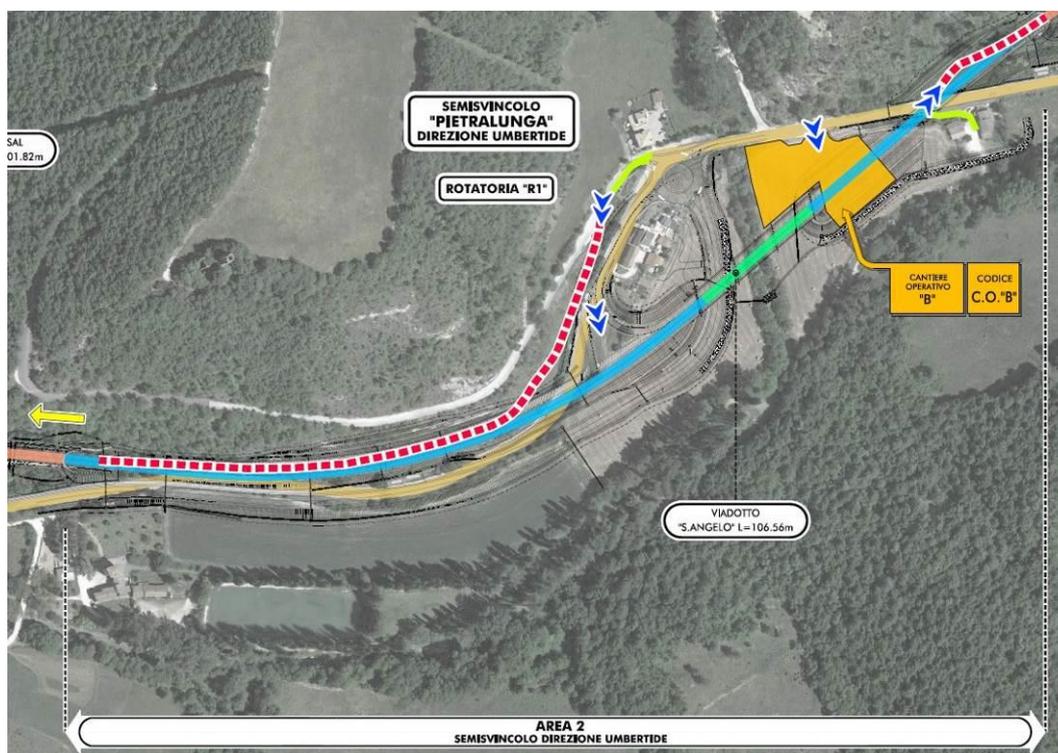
AREA 2: SEMISVINCOLO PIETRALUNGA IN DIREZIONE UMBERTIDE (ESTRATTO DALL'ELAB. T00CA01CANPL02A)
